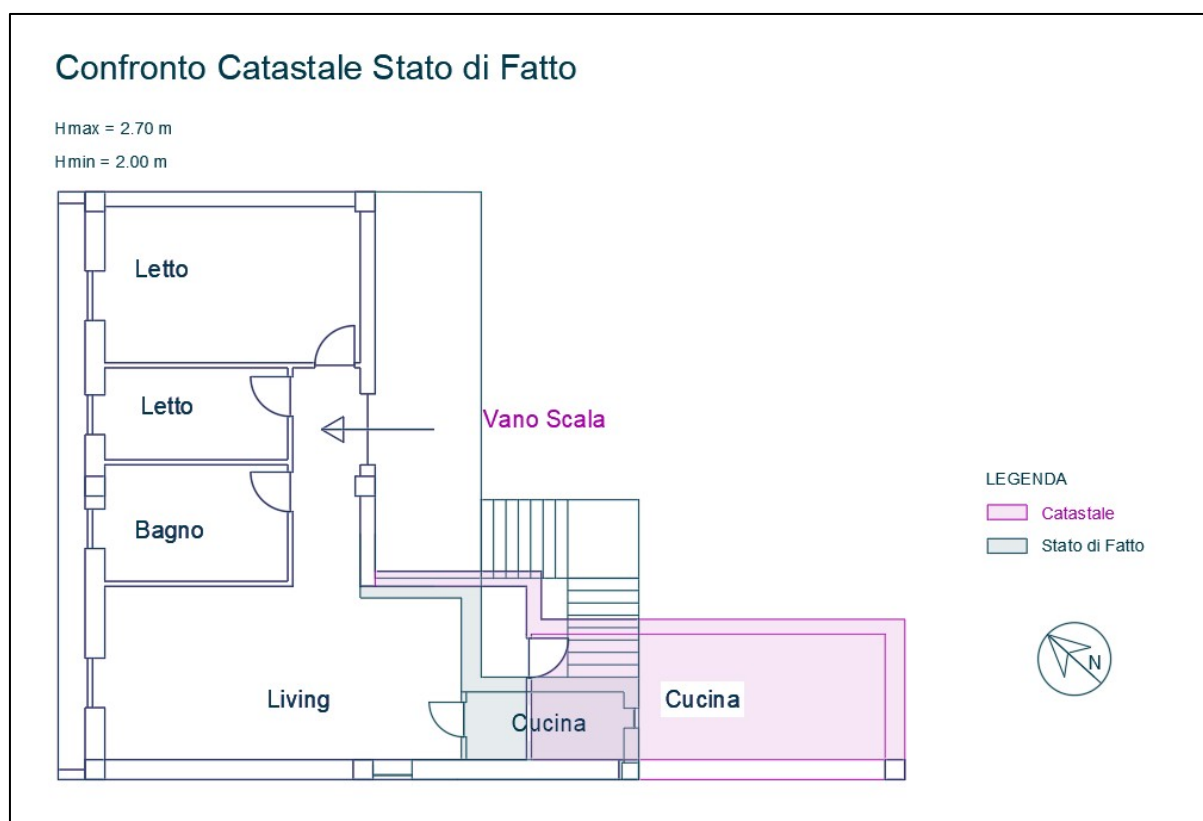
Confronto tra planimetria Catastale e Stato di Fatto
